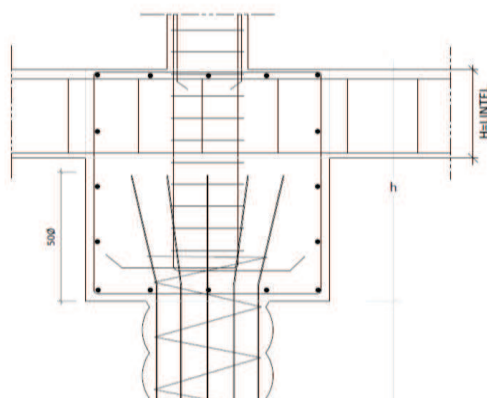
Pormenor construtivo da ligação entre as estacas de trado contínuo, viga lintel e maciços de fundação.
